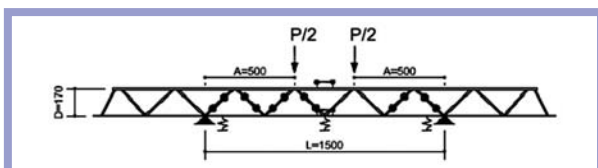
schema di prova e schema statico delle travi per prove a taglio su reticolare in 1° fase
